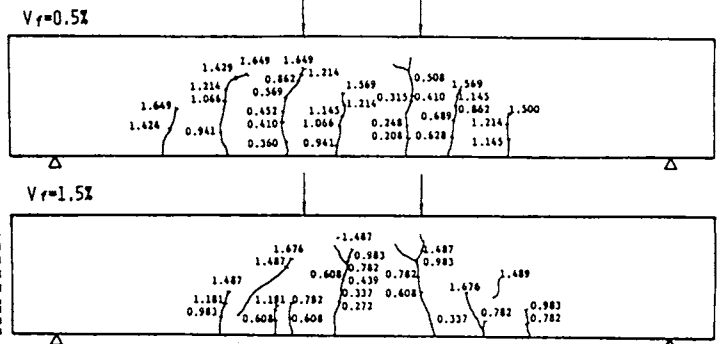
D13鉄筋のSFRCばりのひび割れ状況(実験)
